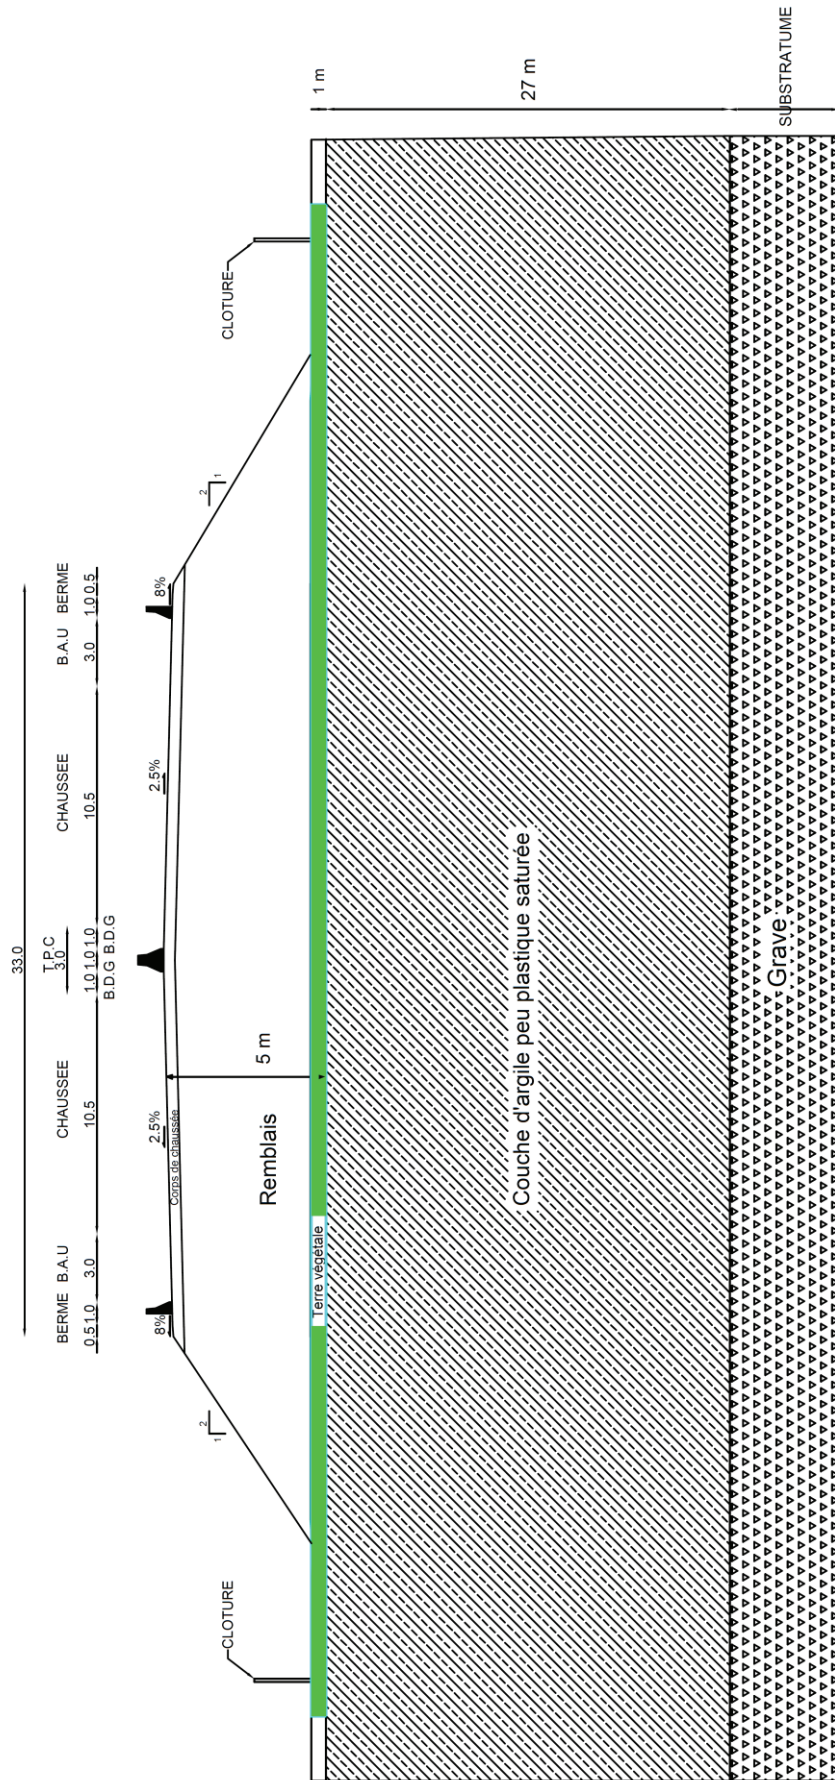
Profil type d'une coupe géotechnique transversal
